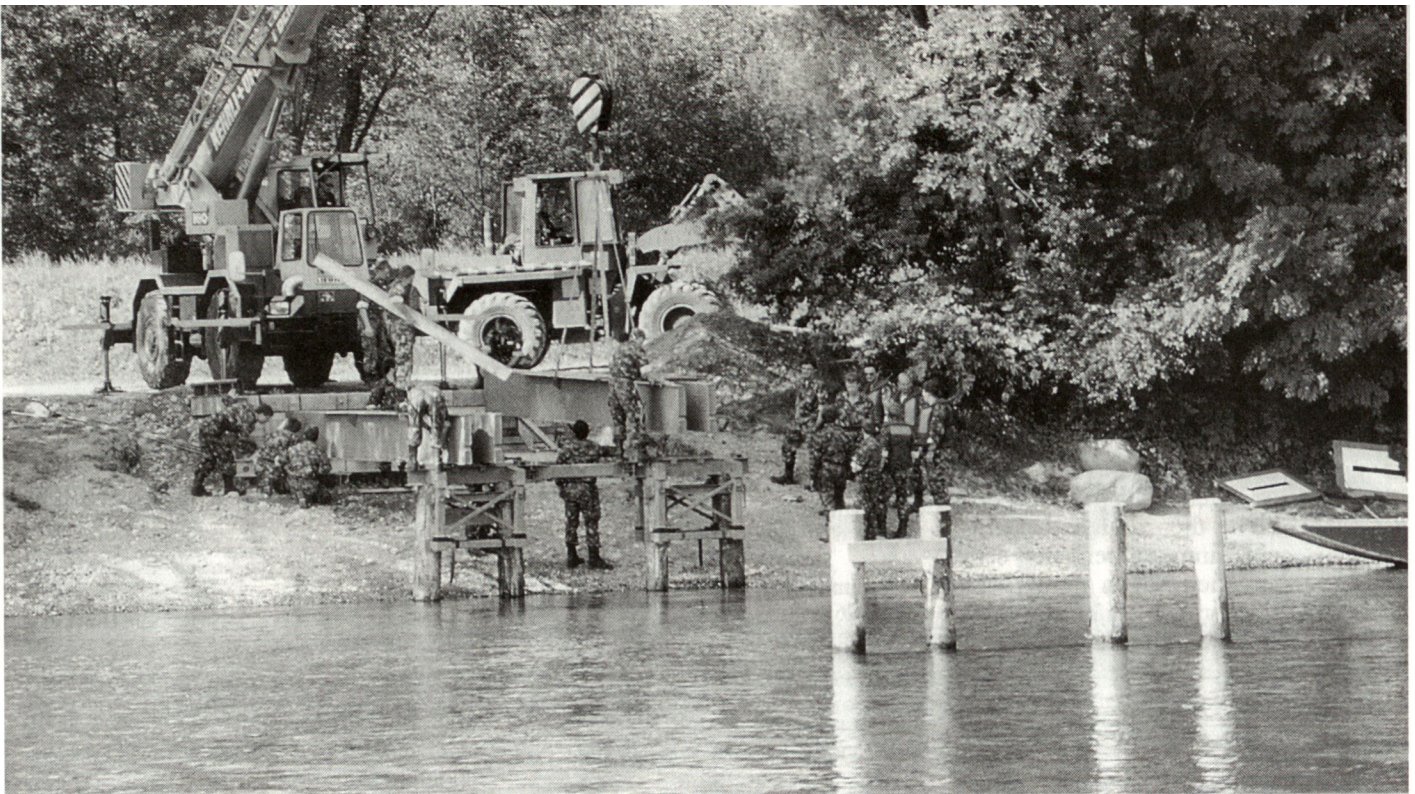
Brückenbau mit Behelfsmaterial: Stahlträger werden auf gerammte Pfahljoche verlegt. (Versuchsstab Genie)
